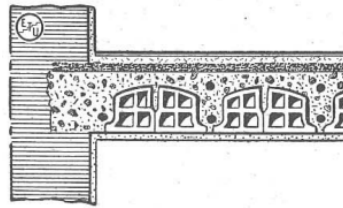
disposizione delle armature in un solaio "Miozzi-Salerni" e il collegamento con la muratura. (fonte: "Solai soffitti coperti, nella moderna edilizia", di Edmondo Protti)
